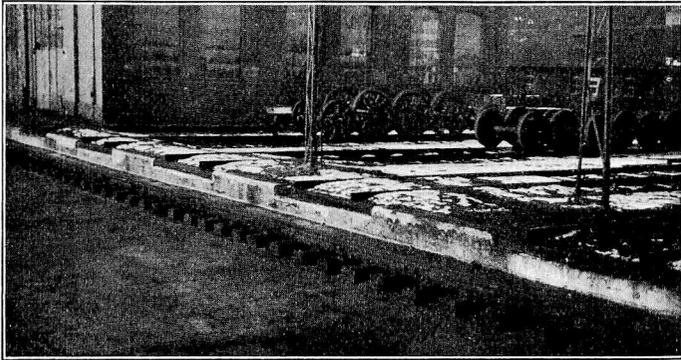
Laufschiene für Schiebebühnen auf Holzschwellen.
